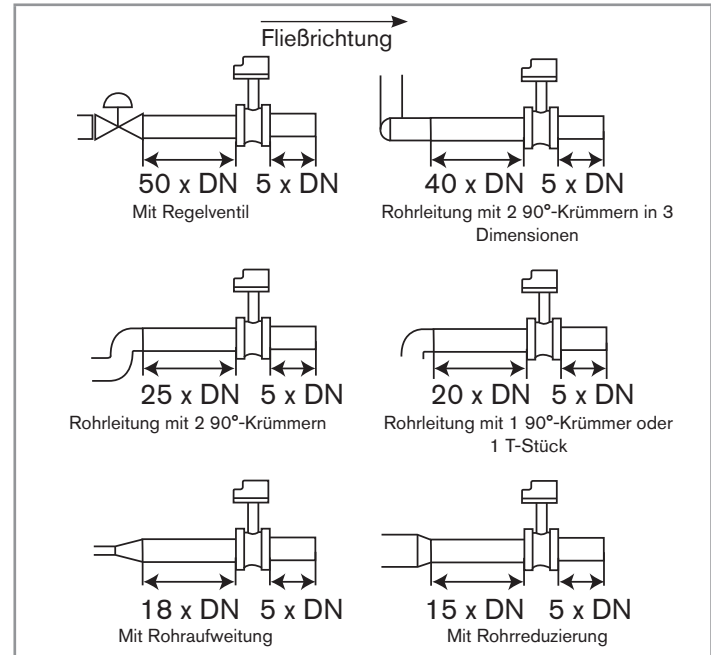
Mindestein- und -auslaufstrecken je nach Aufbau der Rohrleitungen
